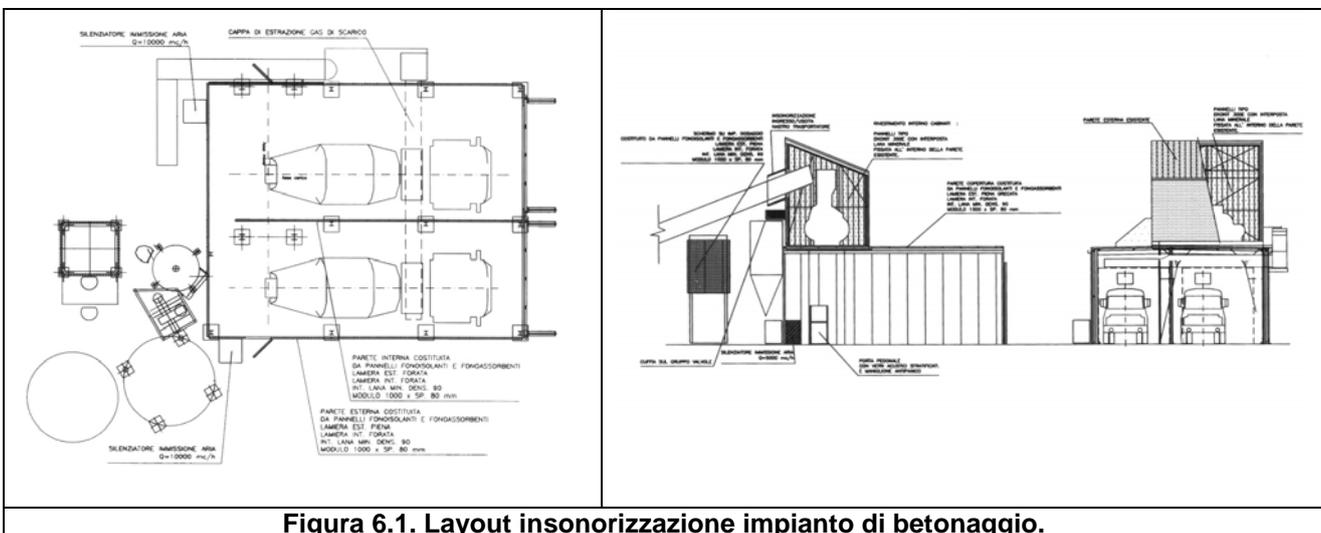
Layout insonorizzazione impianto di betonaggio.
